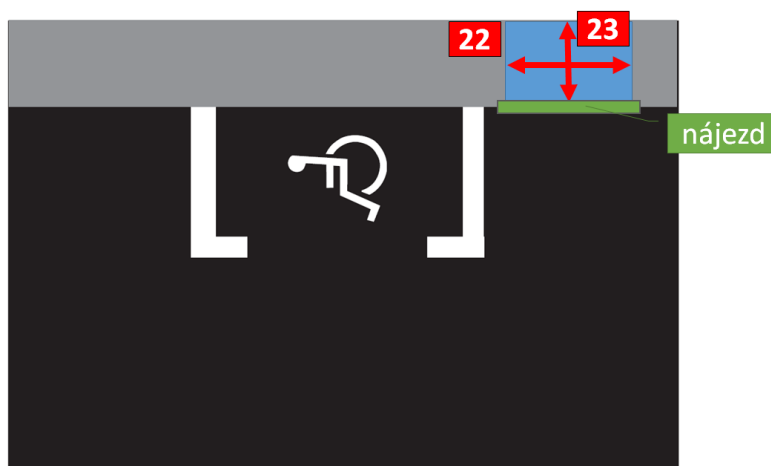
Příklad napojení bez výškových rozdílů – v rovině [foto POV]
